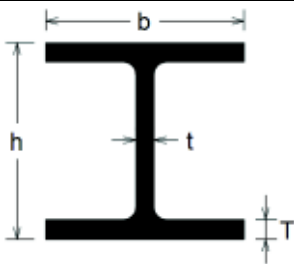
Sección de viga expuesta al fuego en tres de sus caras
